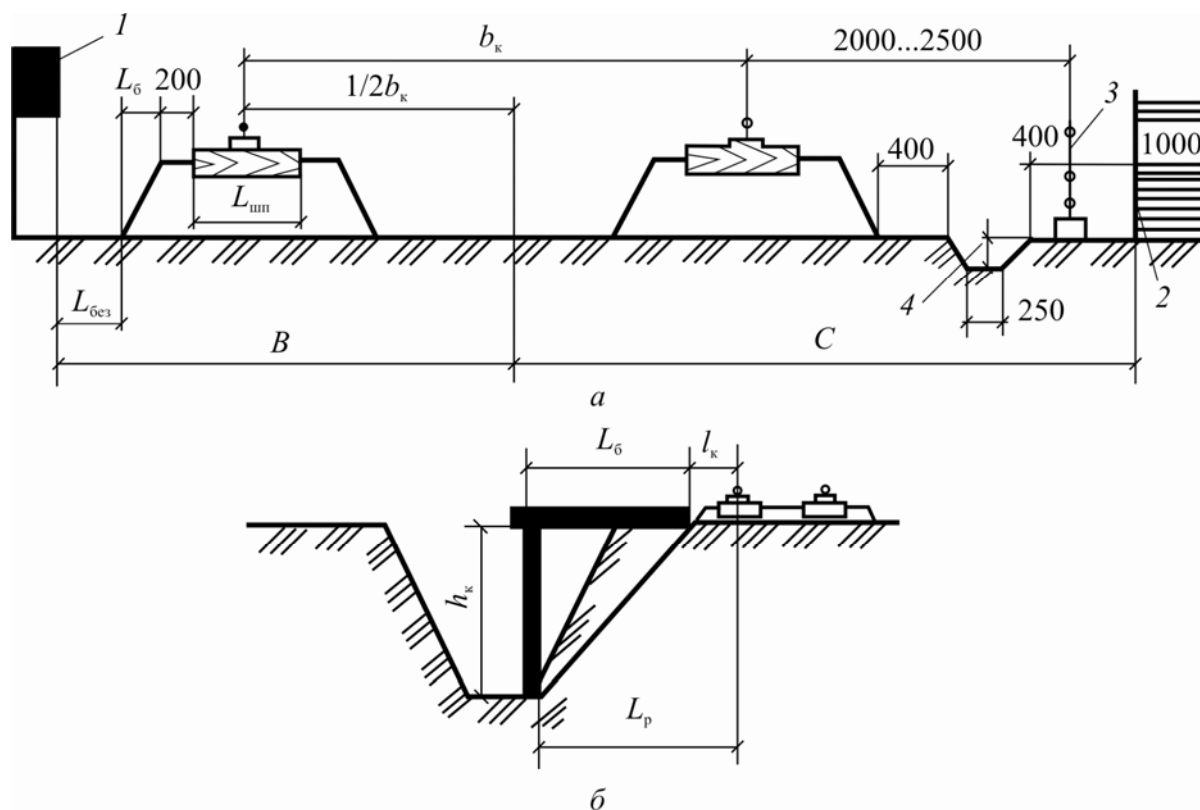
Схема поперечной привязки подкрановых путей: *a* — рядом со зданием; *б* — рядом с котлованом или траншеей: 1 — строящееся здание; 2 — инвентарное ограждение; 3 — зона склада за пределами зоны монтажа; 4 — водоотводная канава
